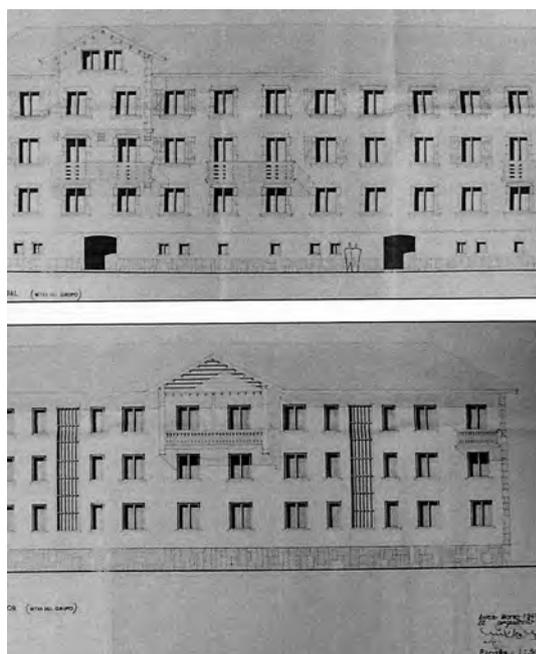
Grupo de viviendas de La Maruca. Fachadas anterior y posterior. Fuente: Cristalería Española, S.A. Viviendas e instalaciones. Caja 1087. Archivo Municipal de Avilés.
